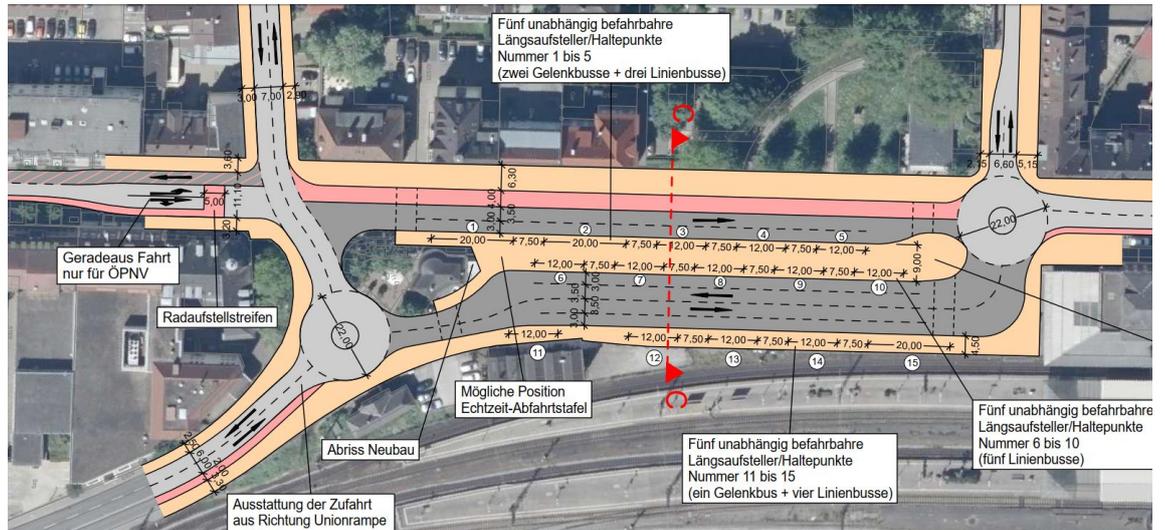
Ausschnitt aus Lageplan Südvergrößerung 3
